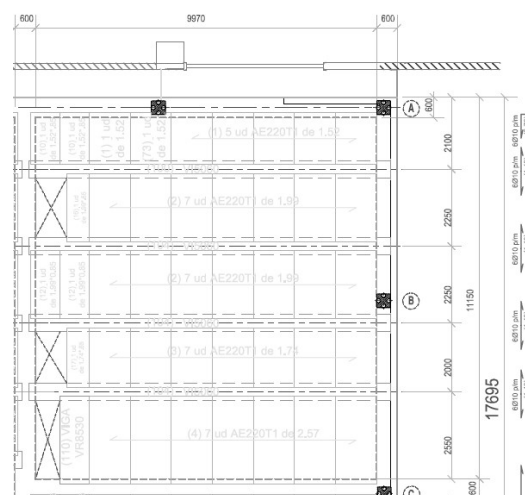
Planta del forjado de cubiertas. Extracto de plano de ejecución original
